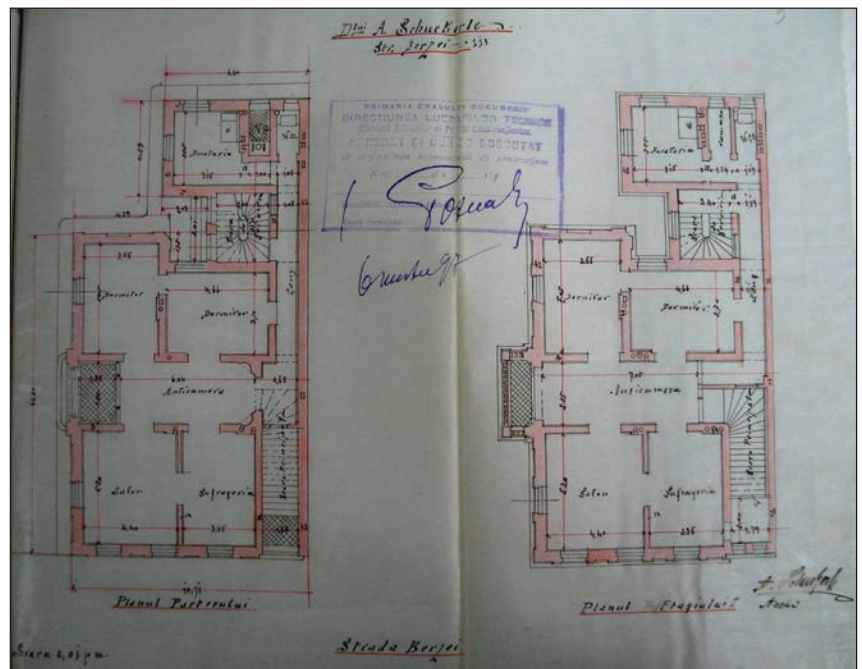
Corpul principal: plan parter și plan etaj - în anul 1897
